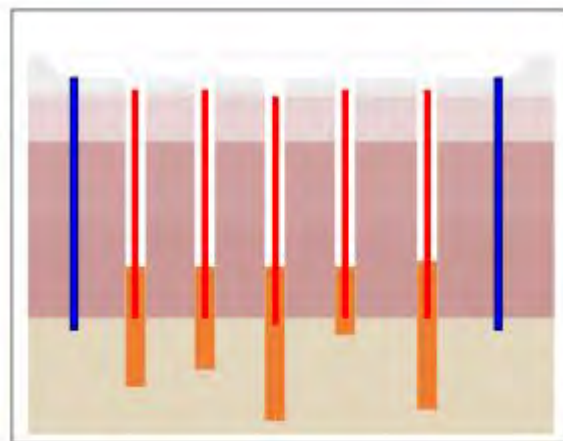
Excavación e instalación de pilotes centrales. Fuente: Pilotes Terratest Perú S.A.C, 2021
